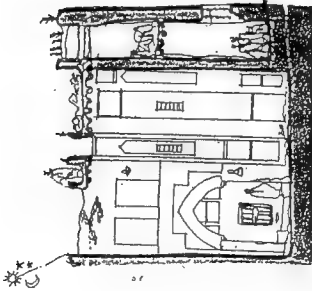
الحائوت الكبير وموقعه من الطريق - مسقط أفقى
